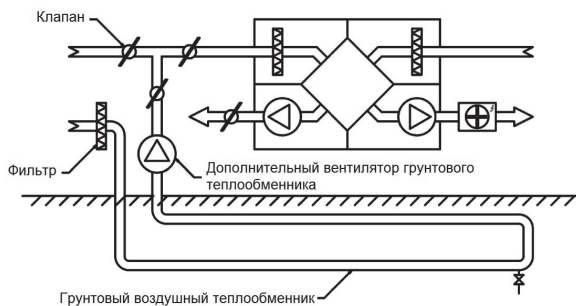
Использование воздушного грунтового теплообменника для предварительного подогрева воздуха
